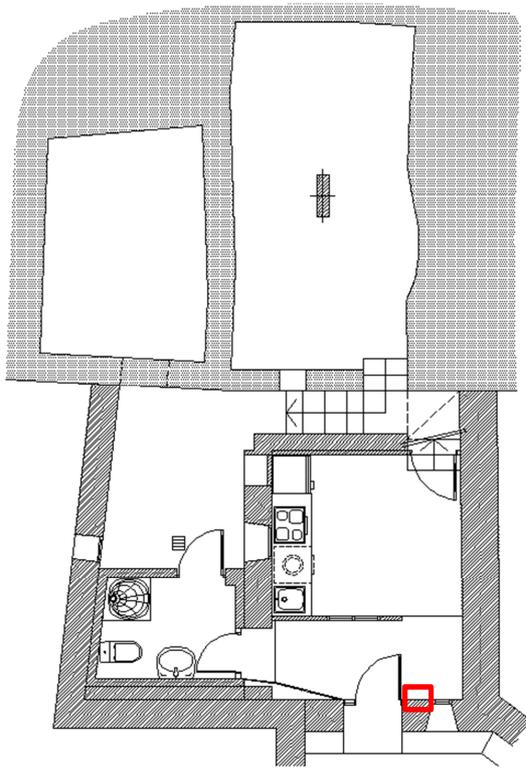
Planta baja y sótano (bodega). Situación de la mancha de humedad en el recibidor de la vivienda.
